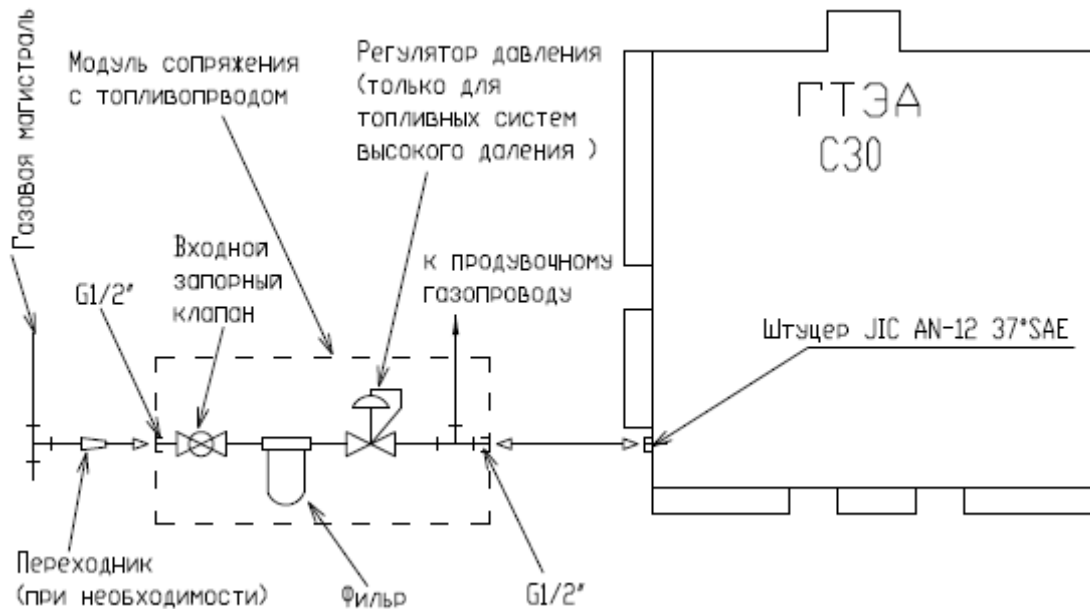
Схема присоединения ГТЭА к газовой магистрали
